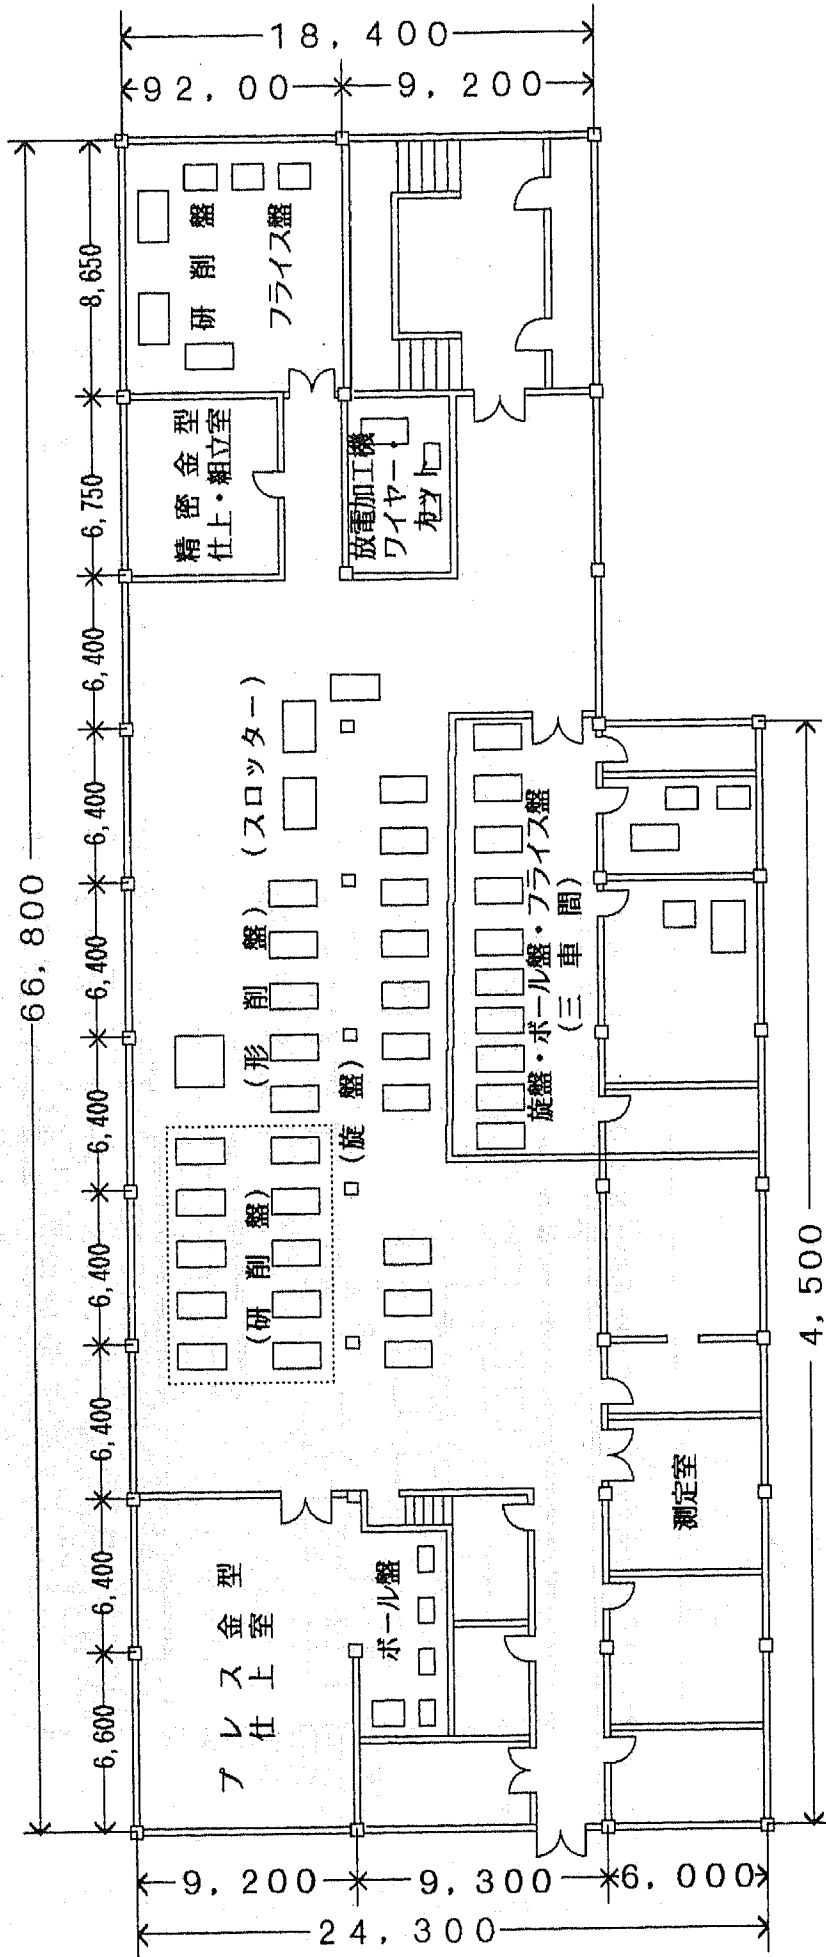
(3) 上海無線電金型工場設備配置図 (4階)
